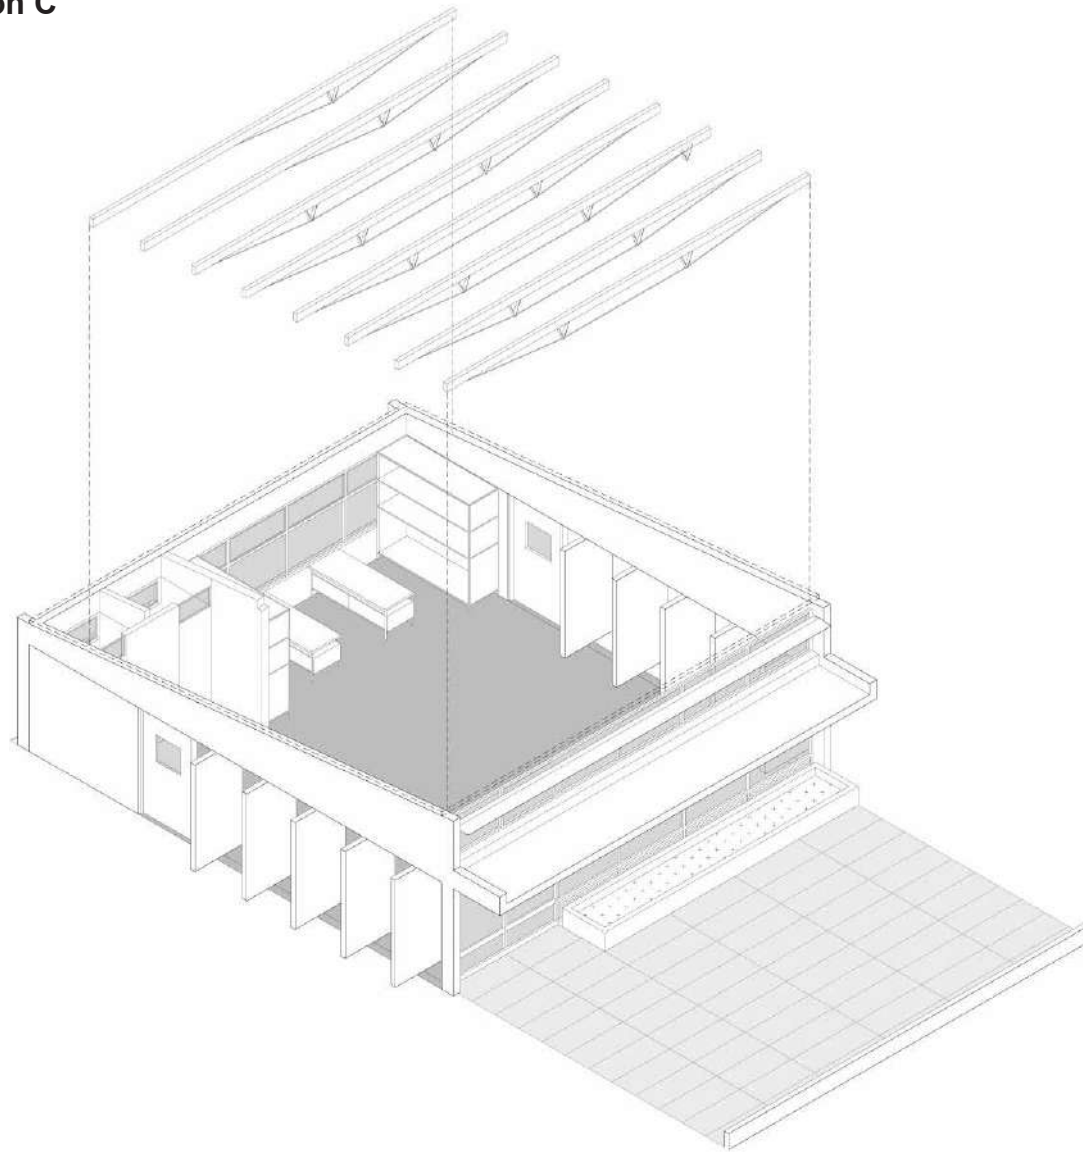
Axonométrica Aula Integral versión C. Fuente: dibujo del autor.
